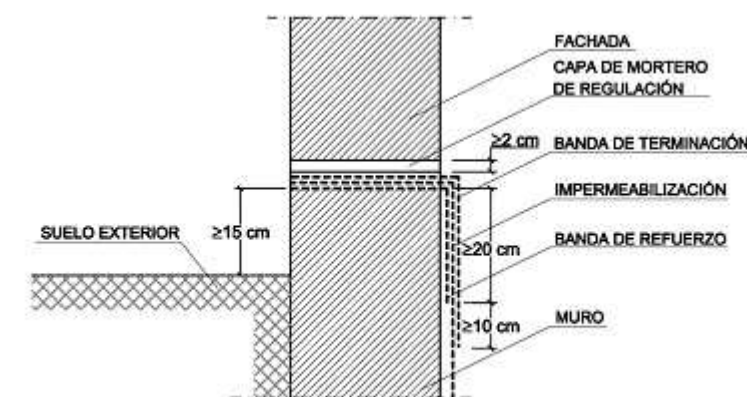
Ejemplo de encuentro de un muro impermeabilizado por el interior con lámina con una fachada
